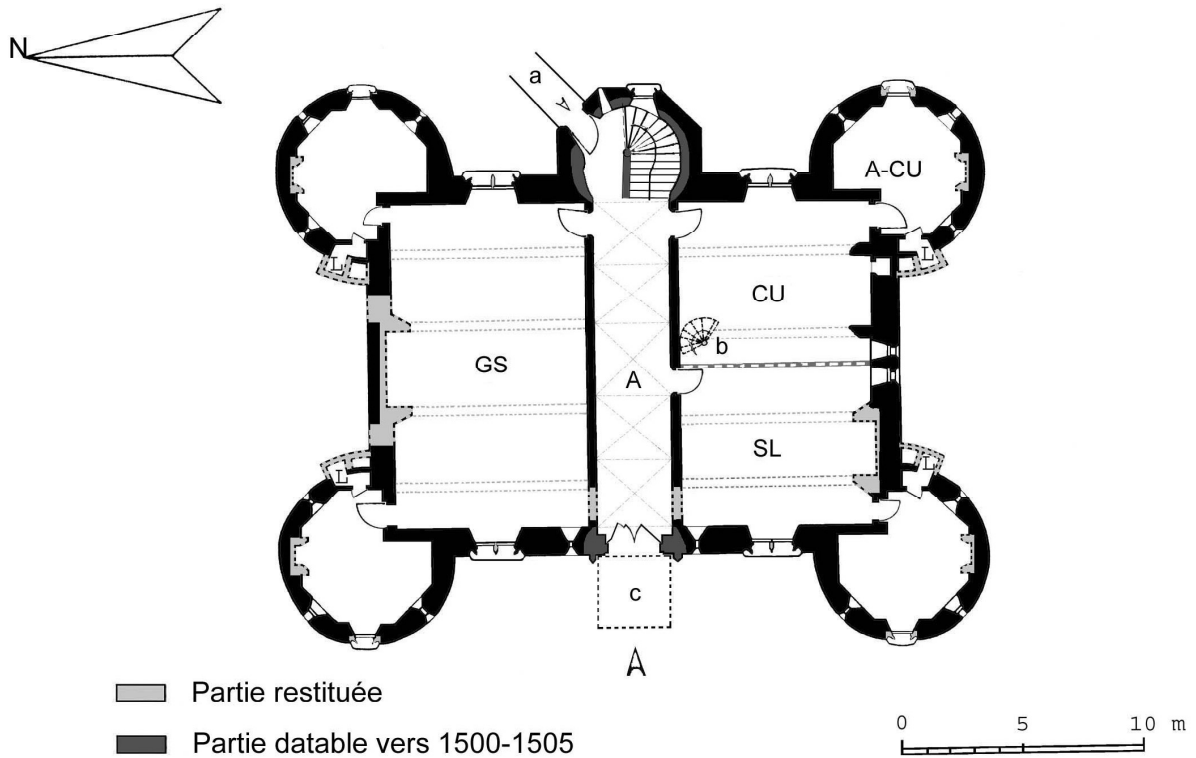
Martainville. Plan restitué du rez-de-chaussée vers 1500-1505.
